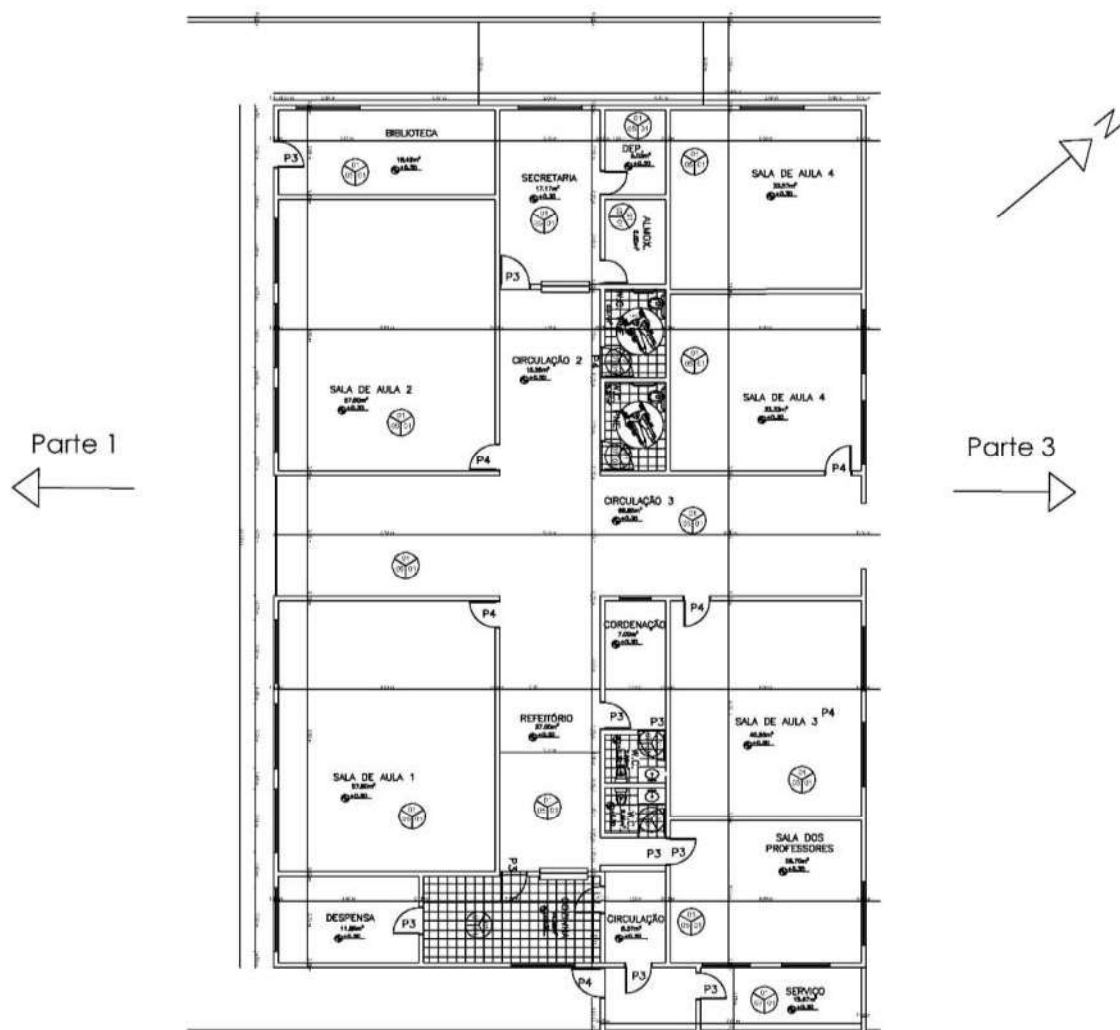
Planta Baixa Parte 2, Delmiro Gouveia – AL
